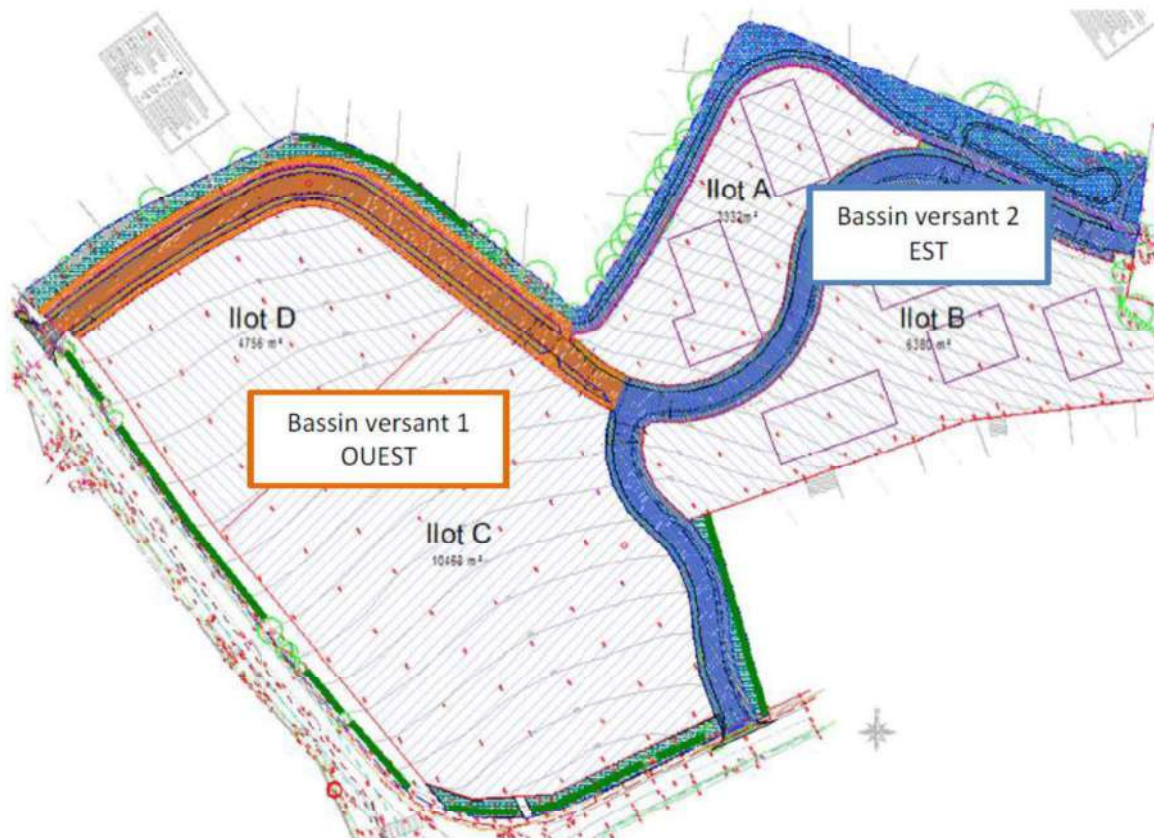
Plan des bassins versants (Source : SERVICAD)
